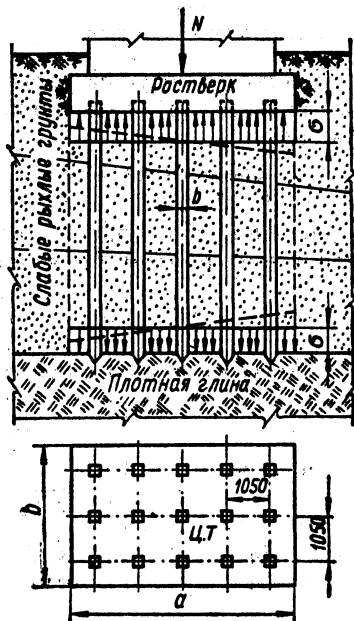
Свайный фундамент (куст) из свай-стоек.
